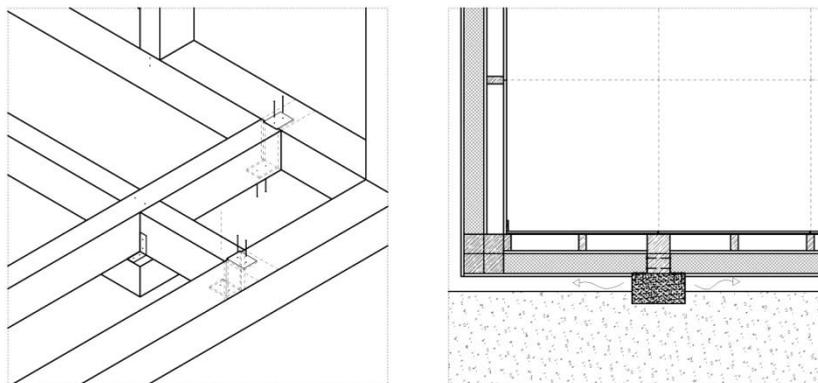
> Pormenor de ligação dos blocos de betão com o solo e com a estrutura da casa, à escala 1/50
